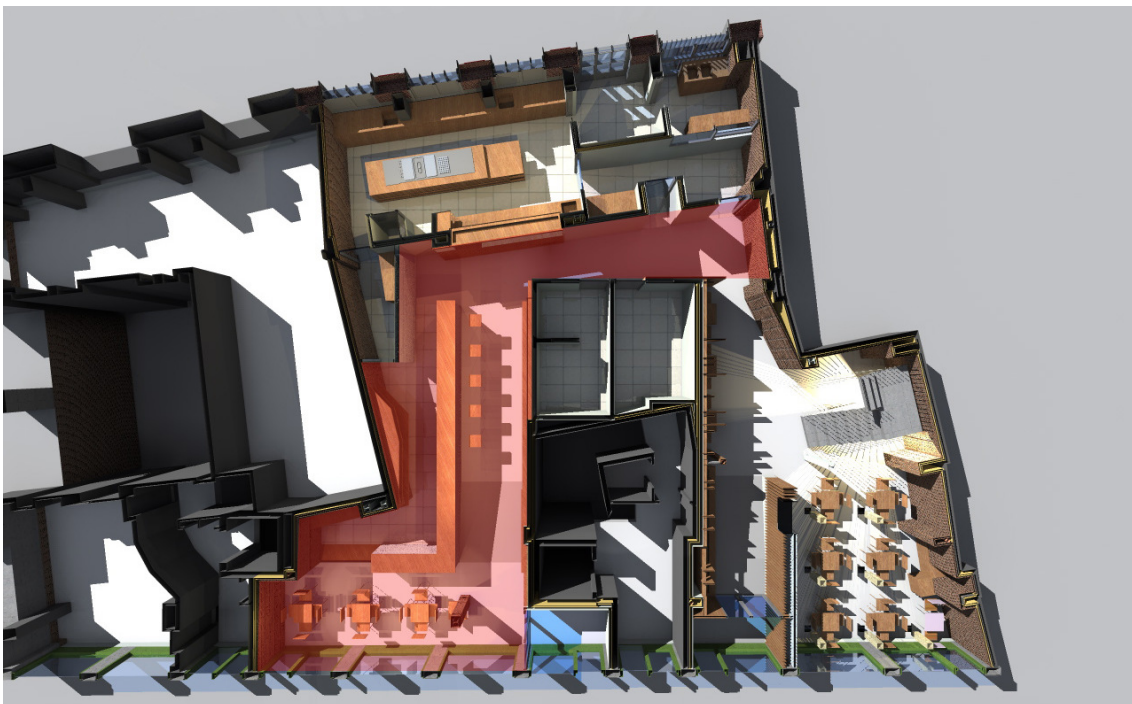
Tiempo de reverberación: Zona de bar y pasillo de acceso a aseos (Planta baja).
